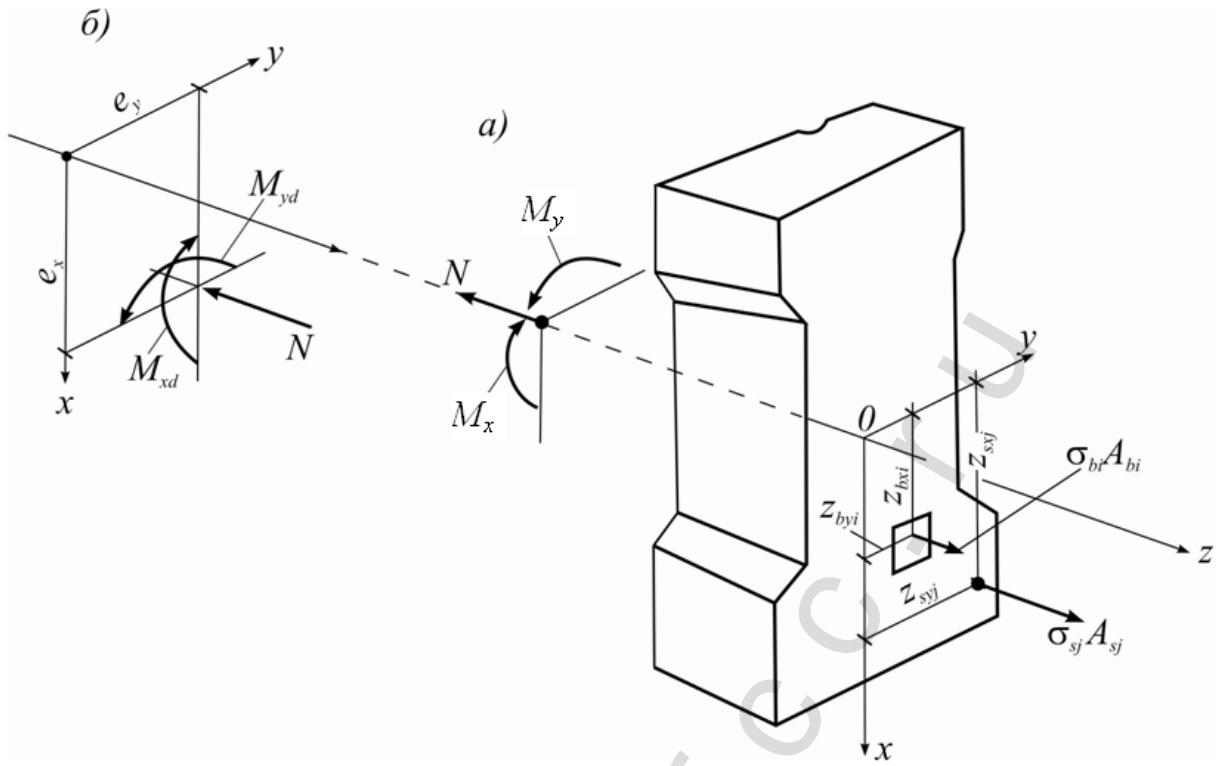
Расчетная схема нормального сечения железобетонного элемента
